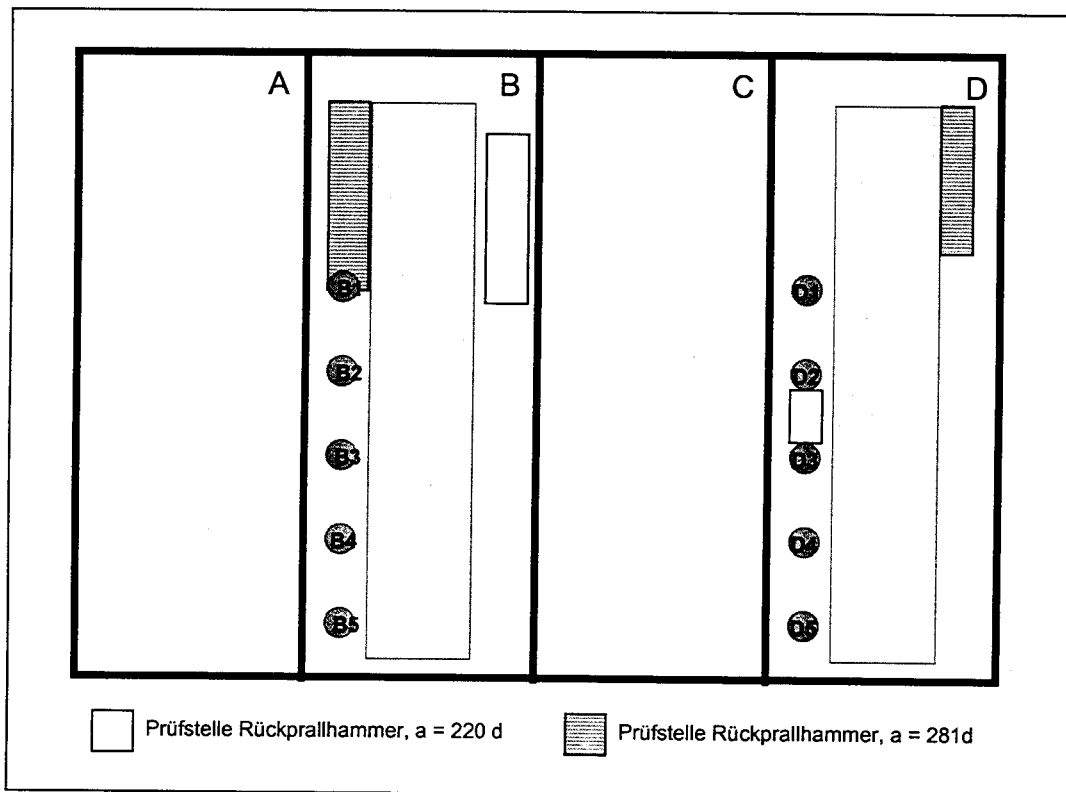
Lage der Prüfflächen am Betonkörper 26
